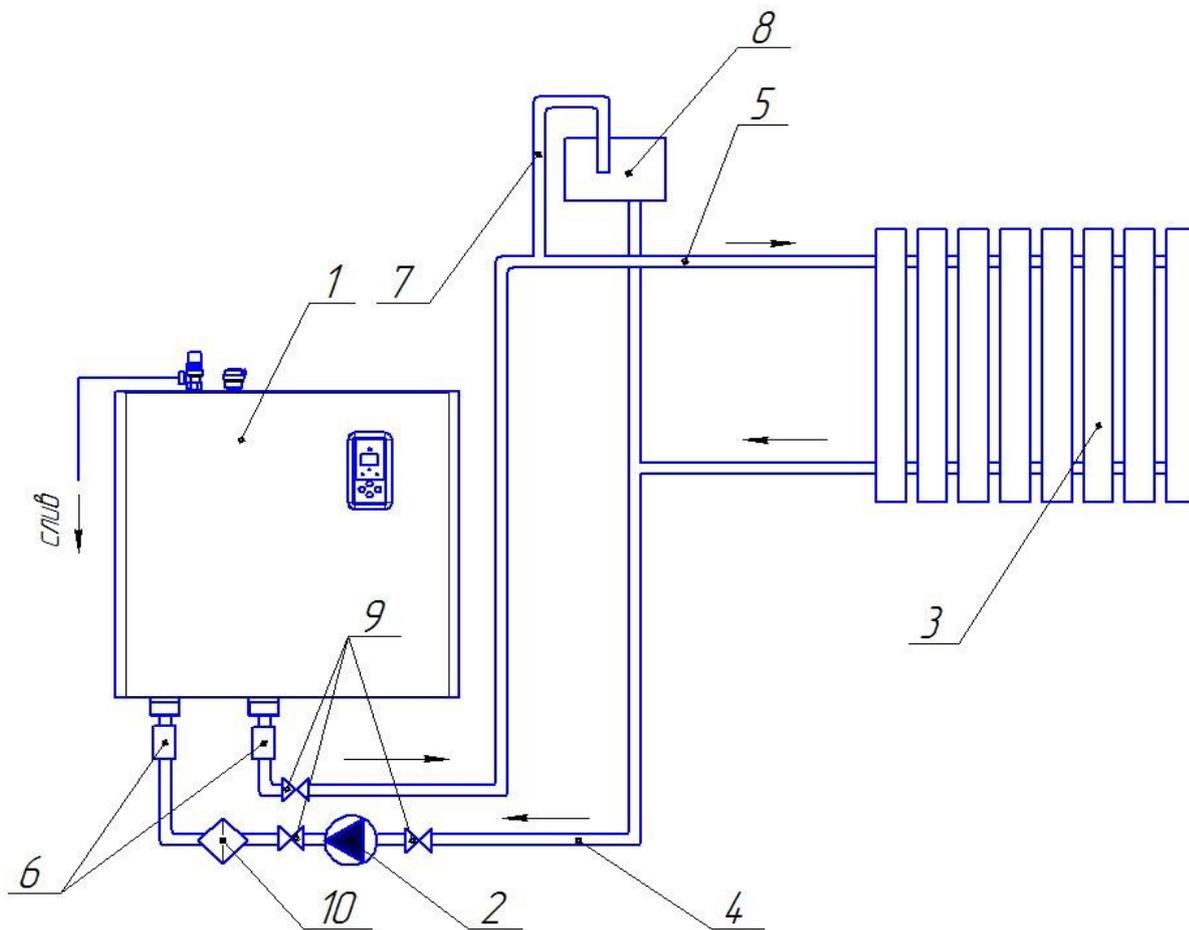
Упрощенная схема использования ЭВН-К в системе отопления (Вариант 1)
